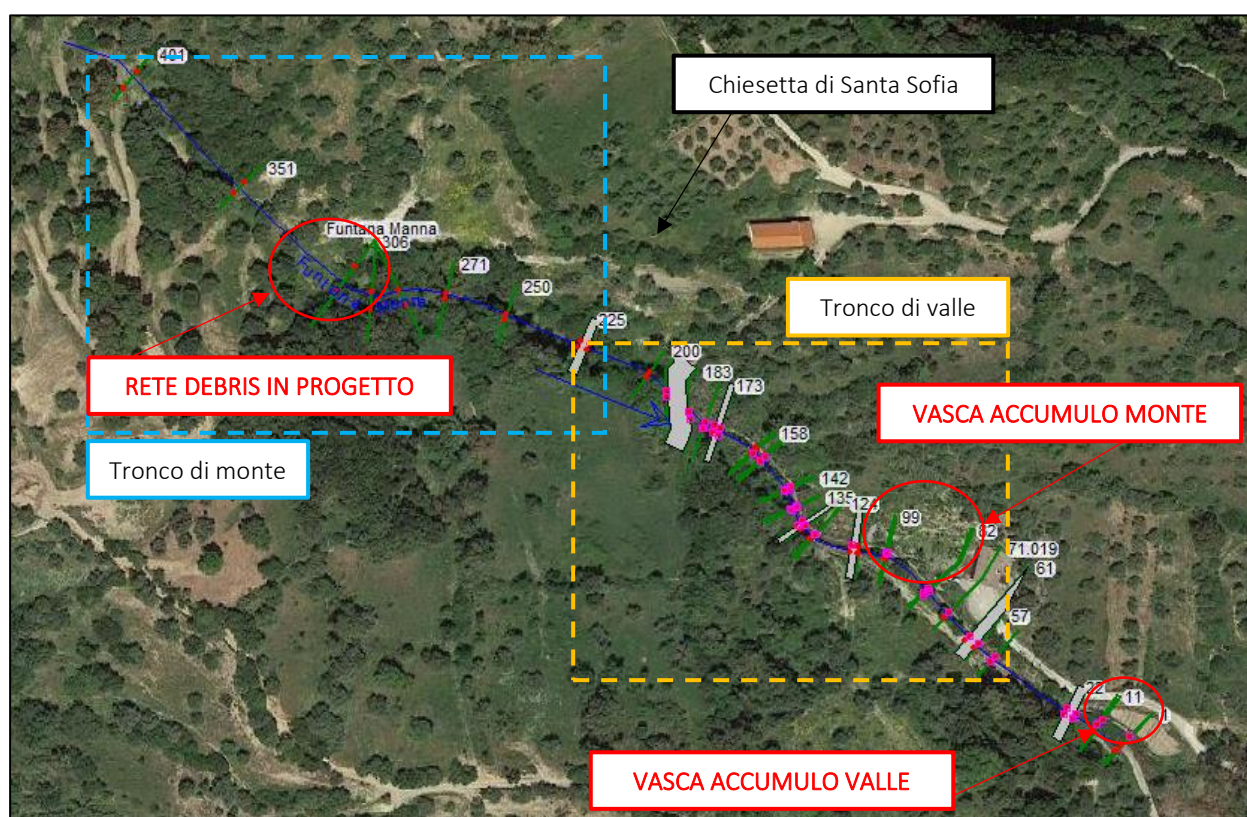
Planimetria di ubicazione delle sezioni di calcolo e degli interventi in progetto.
